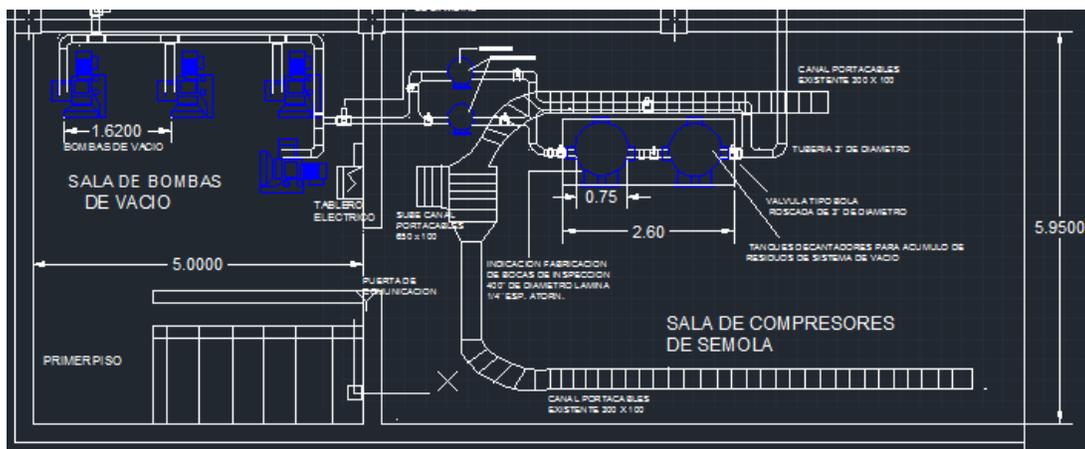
Vista de planta de la sala de bombas de vacío actual
